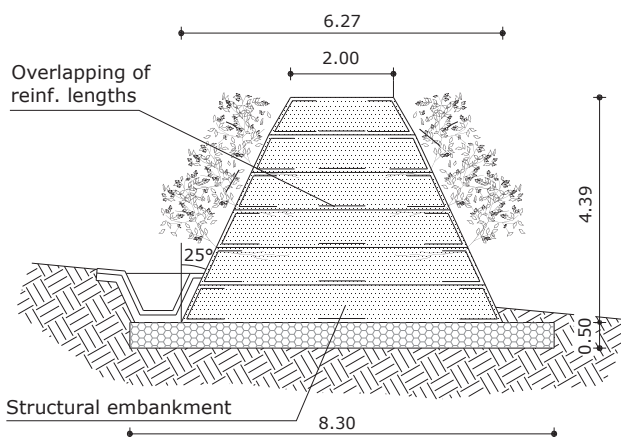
Typischer Querschnitt eines Murgangdammes als bewehrter Erdwall
